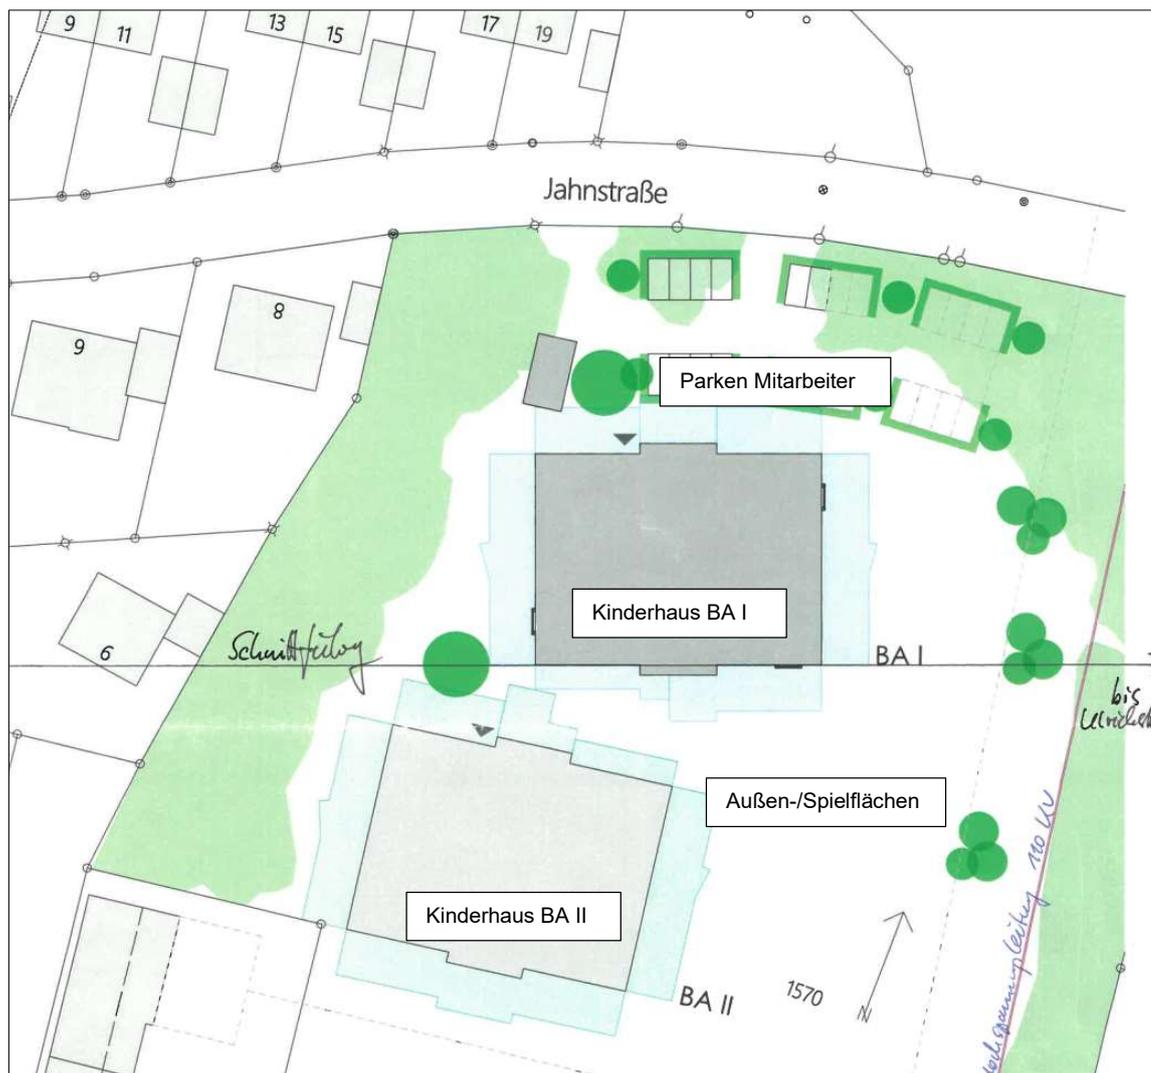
Lageplan mit Darstellung der Baumaßnahme der Gesamtanlage (BA I + BA II) gemäß [a]
